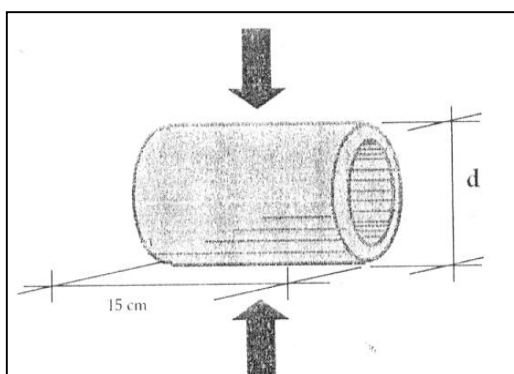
Dimensiones de las probetas para el ensayo de compresión perpendicular.
